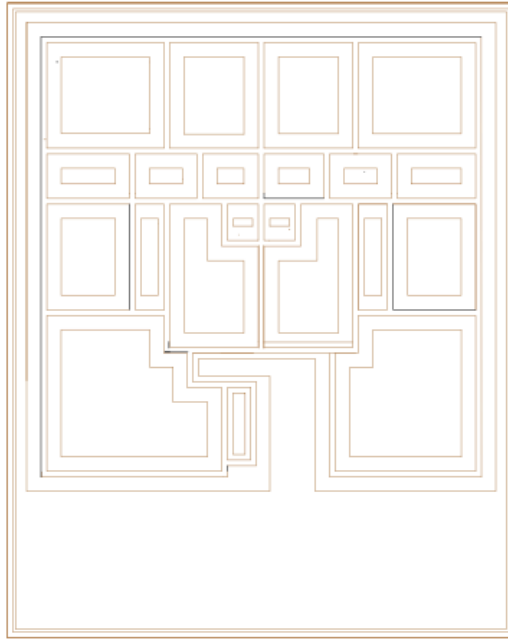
Plano estructural de zapata corrida en dos sentidos.
